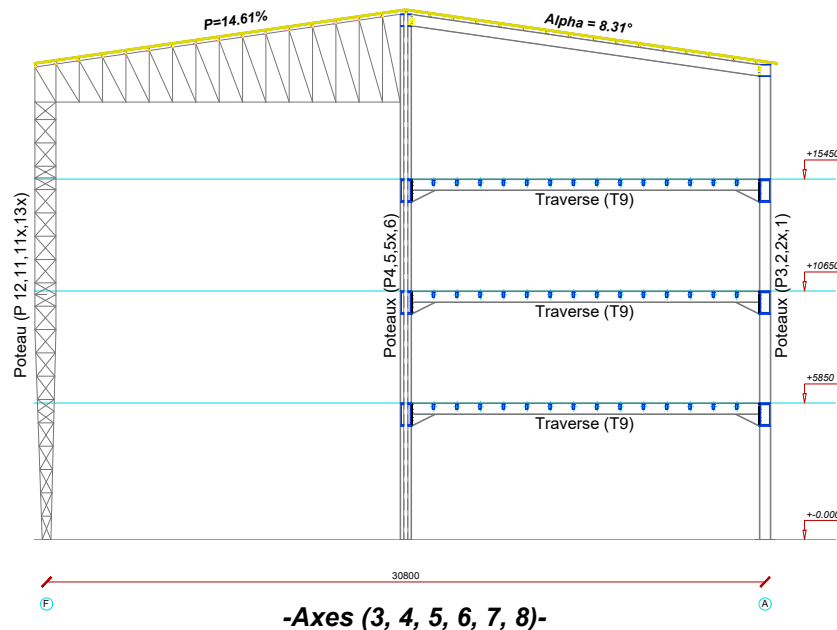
Portique secondaire supportant les planchers intermédiaires et la toiture.
